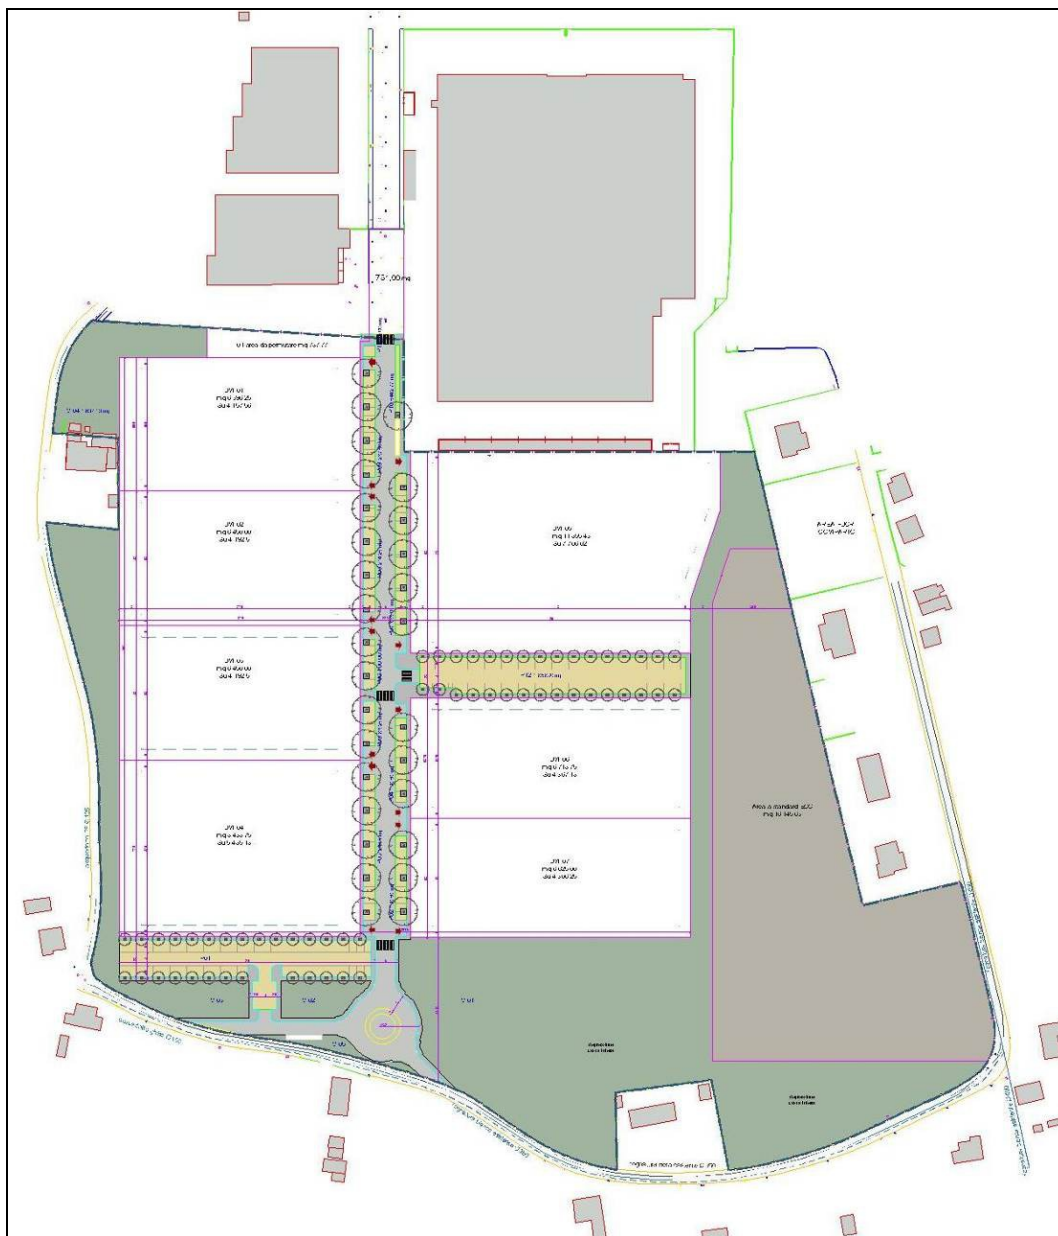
Rappresentazione planimetrica dell'intervento in progetto
